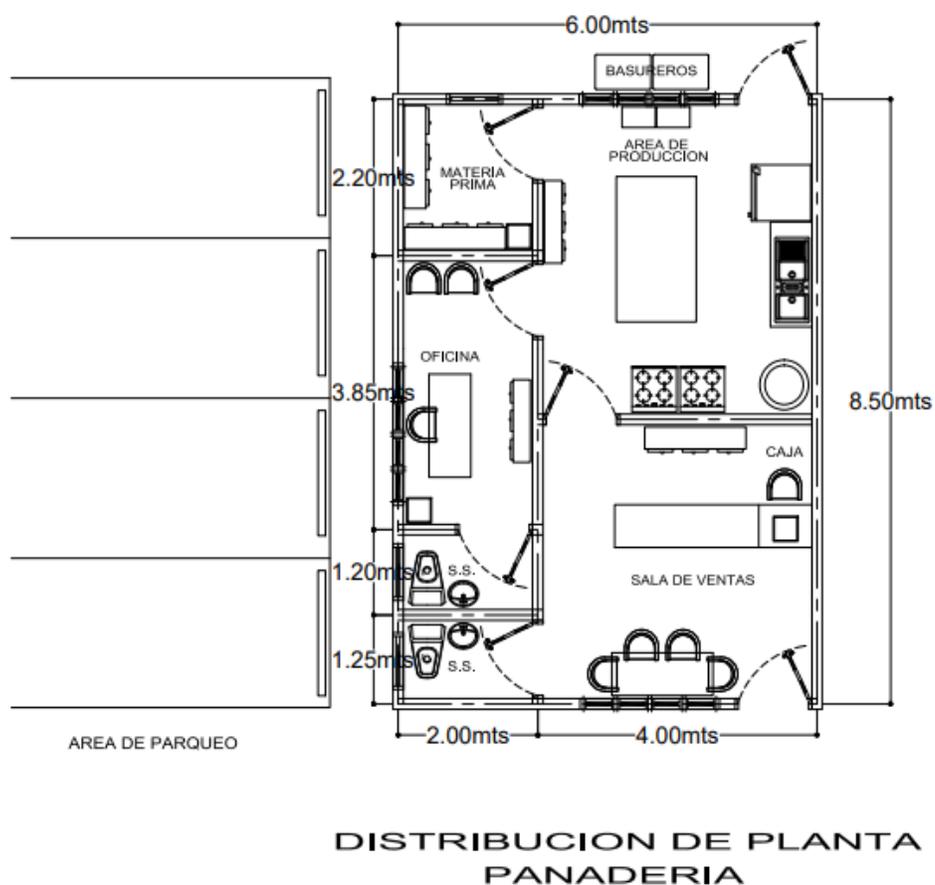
Plano de la instalación de la panadería El Trigal de Oro
